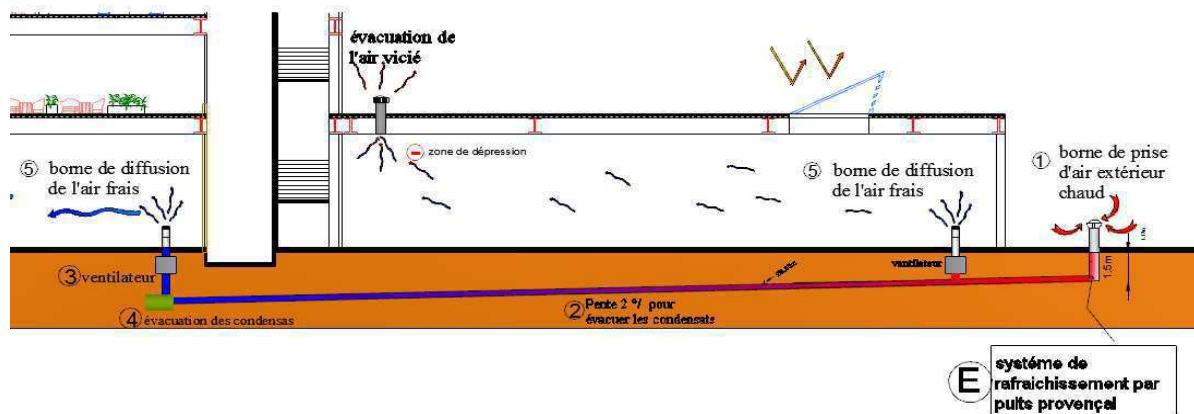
zoom sur le principe de fonctionnement d'un puits canadien coupe D-D.
